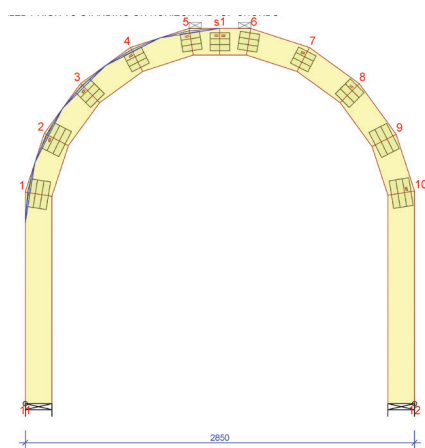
przedstawia konstrukcję dachu łukowego. Kształt dachu i profil ruachu opracowuje architekt. Na podstawie
